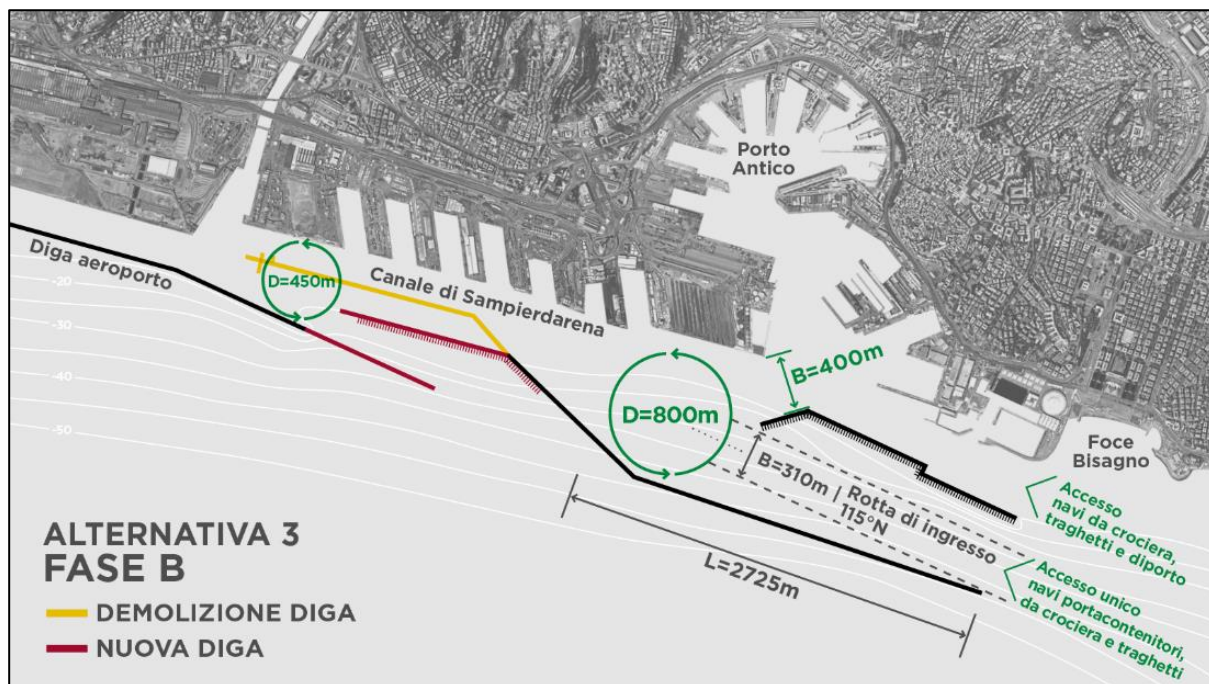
Planimetria della nuova diga foranea nella sua configurazione finale
